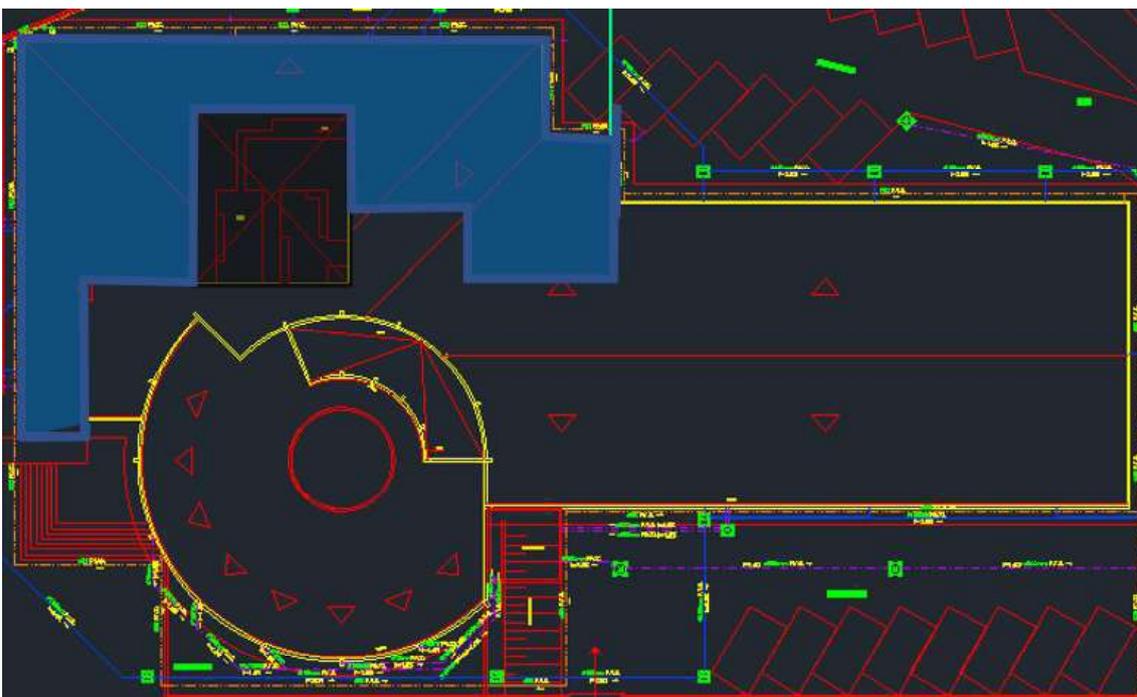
Área em Azul a ser considerada (Laje) para troca de telhado (telhas trapezoidais sem preenchimento) - Área total de 396 m²
